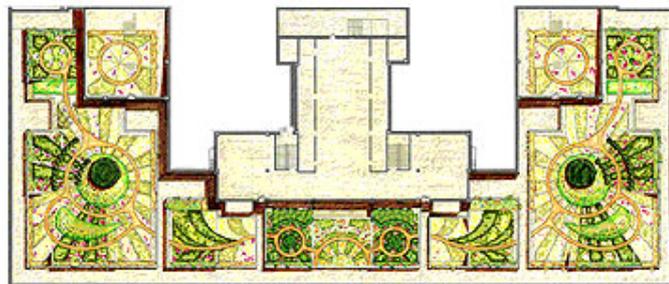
Planta baixa do telhado verde da prefeitura de Chicago (parte não ajardinada ao centro)
